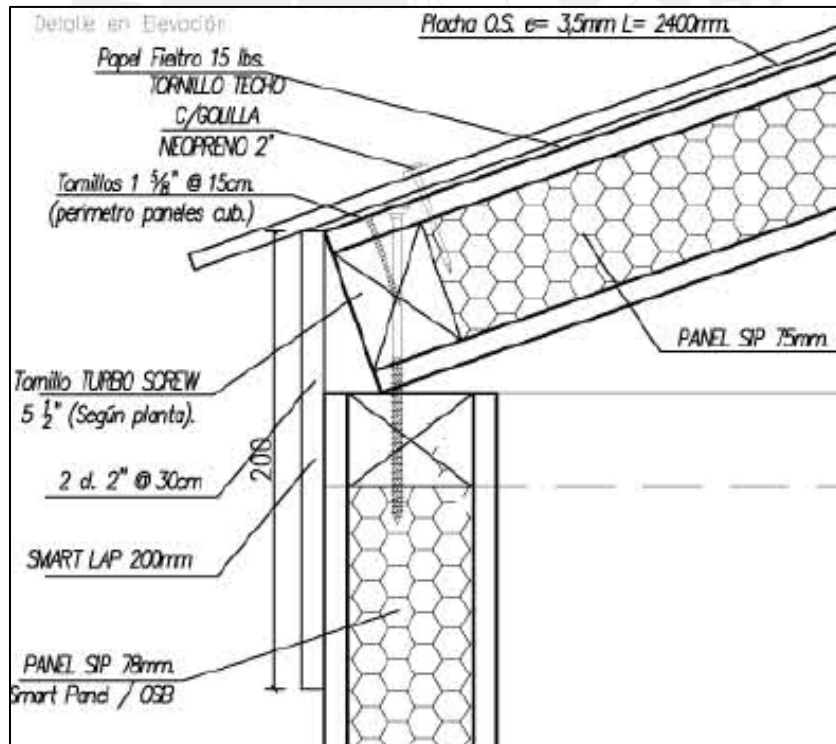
Figura XXI: Detalle de encuentro de paneles para muro y techo – modelo 3
